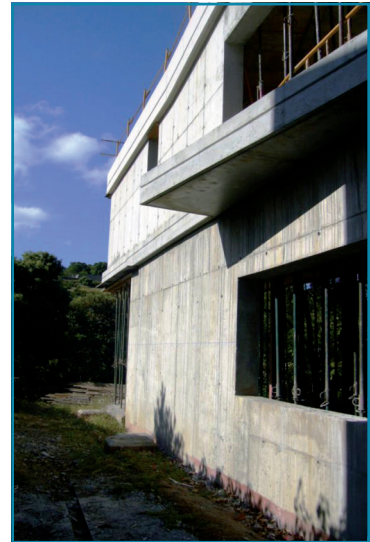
Perfil exterior de la vivienda en construcción. Fotografía: M^a Teresa Hontoria.
